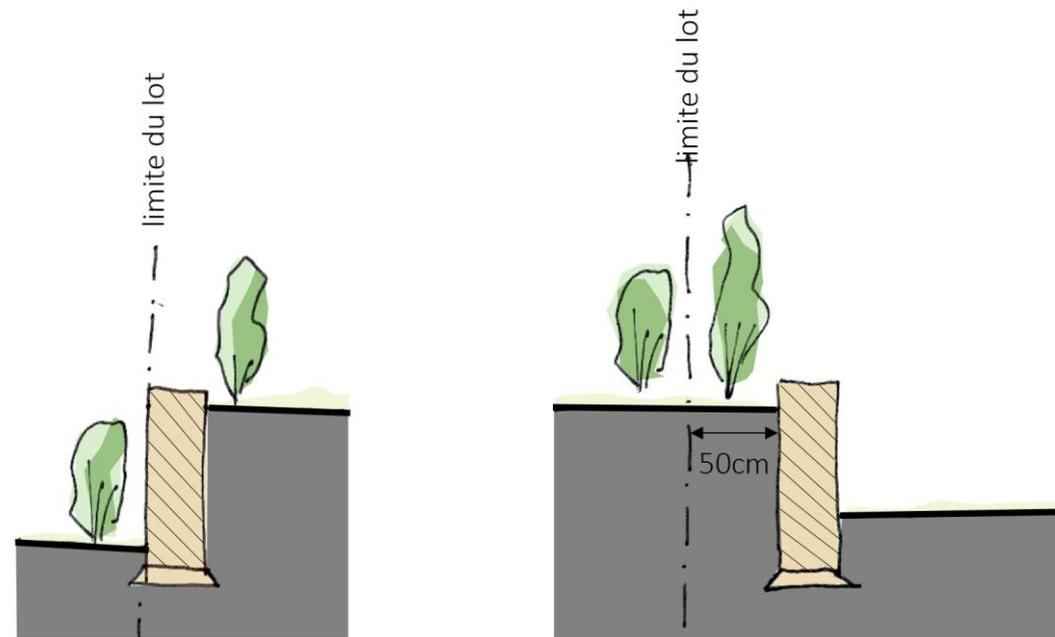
schéma d'implantation des gabions ou des murets en pierre sèche sur la limite du lot
